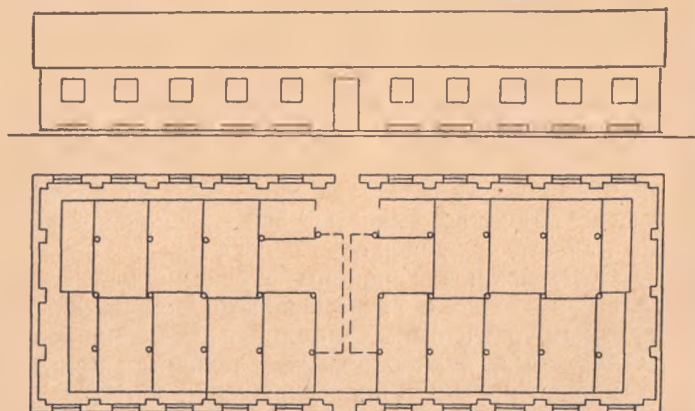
Фасад и план семеновранилища емкостью 500 т.
